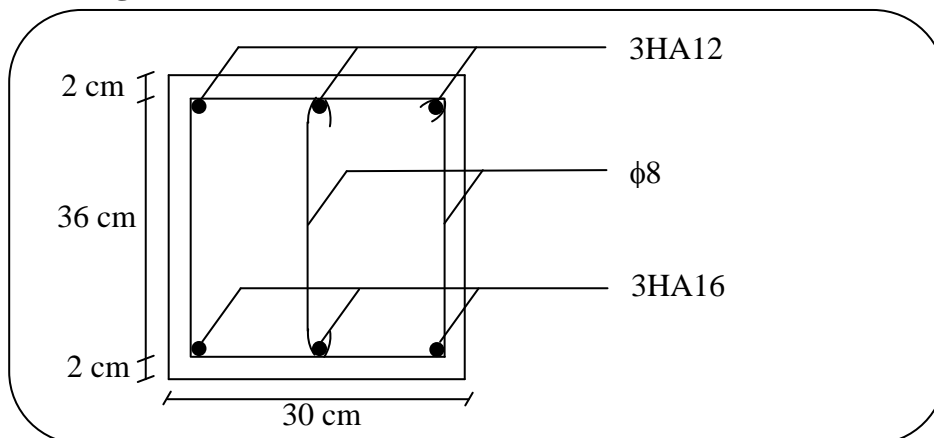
Schéma de ferrailage du chaînage 3
